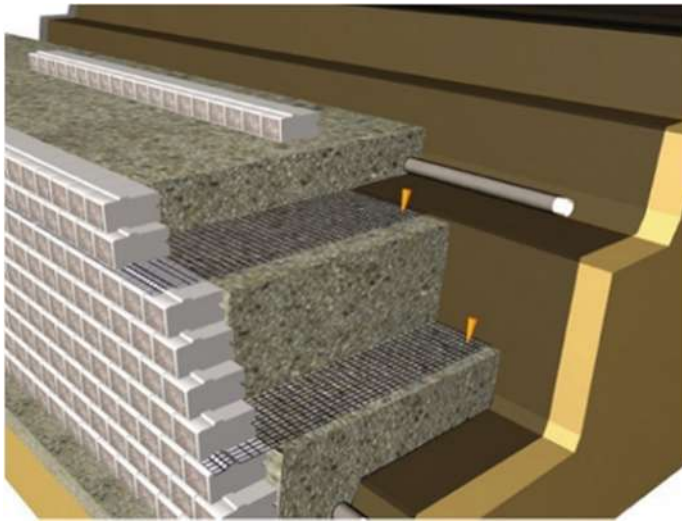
Croquis de proceso constructivo para carretera fed. 120
